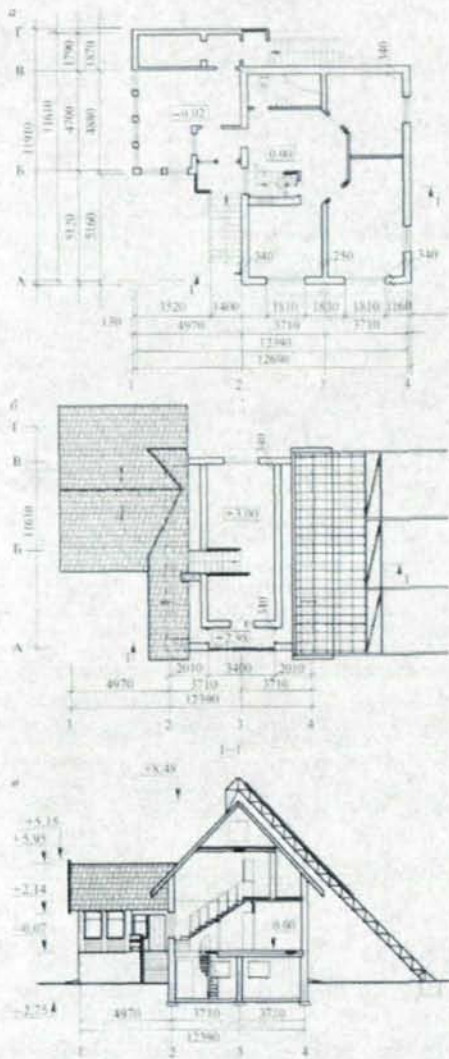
Экспериментальный жилой дом (пос.Черноморский, Краснодарский край): а- план 1-го эт. на отм.0,00; б- план мансардного эт. на отм. +3,00; в- разрез 1-1
